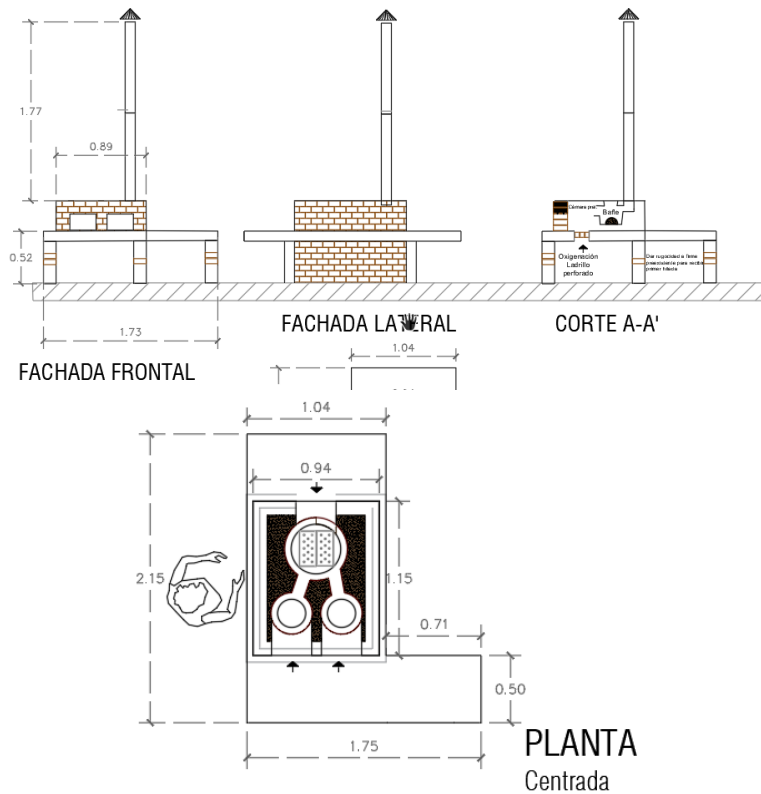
Propuesta de planta arquitectónica de estufa con alzados, ( autoría propia )
